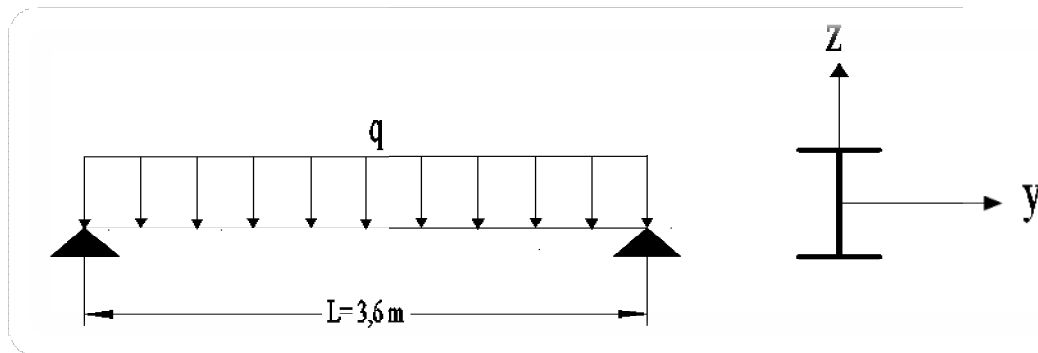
Schéma statique de la poutre la plus sollicitée.
